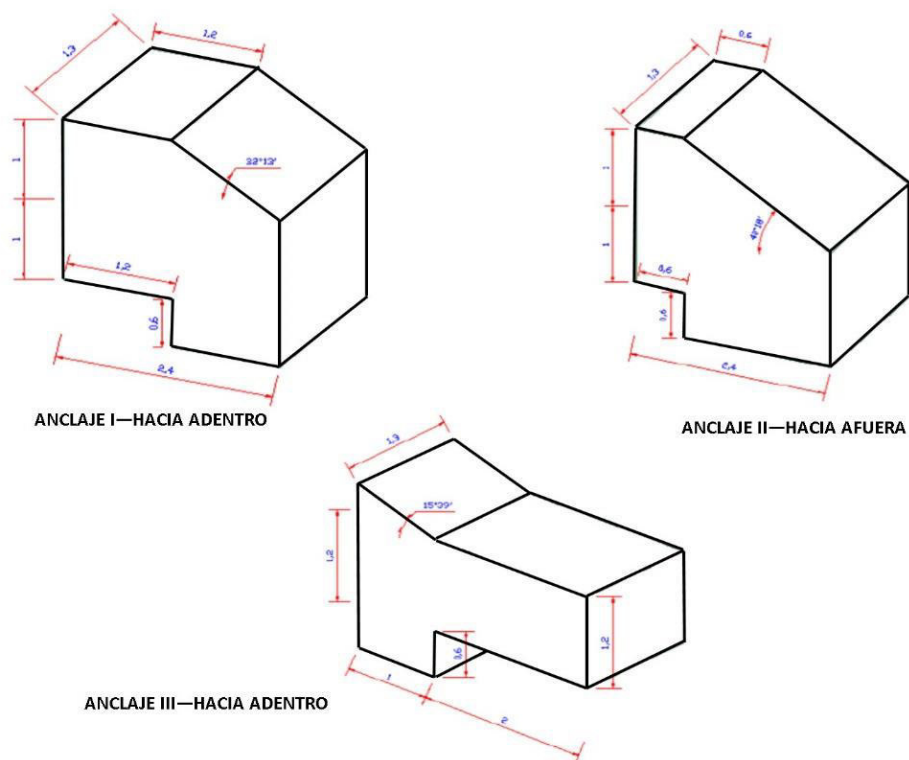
Diversos tipos de anclajes para la tubería forzada
